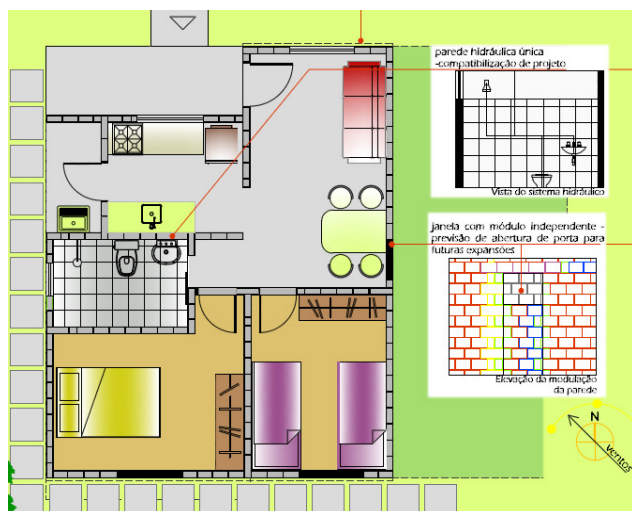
Planta da tipologia unifamiliar e detalhes.
